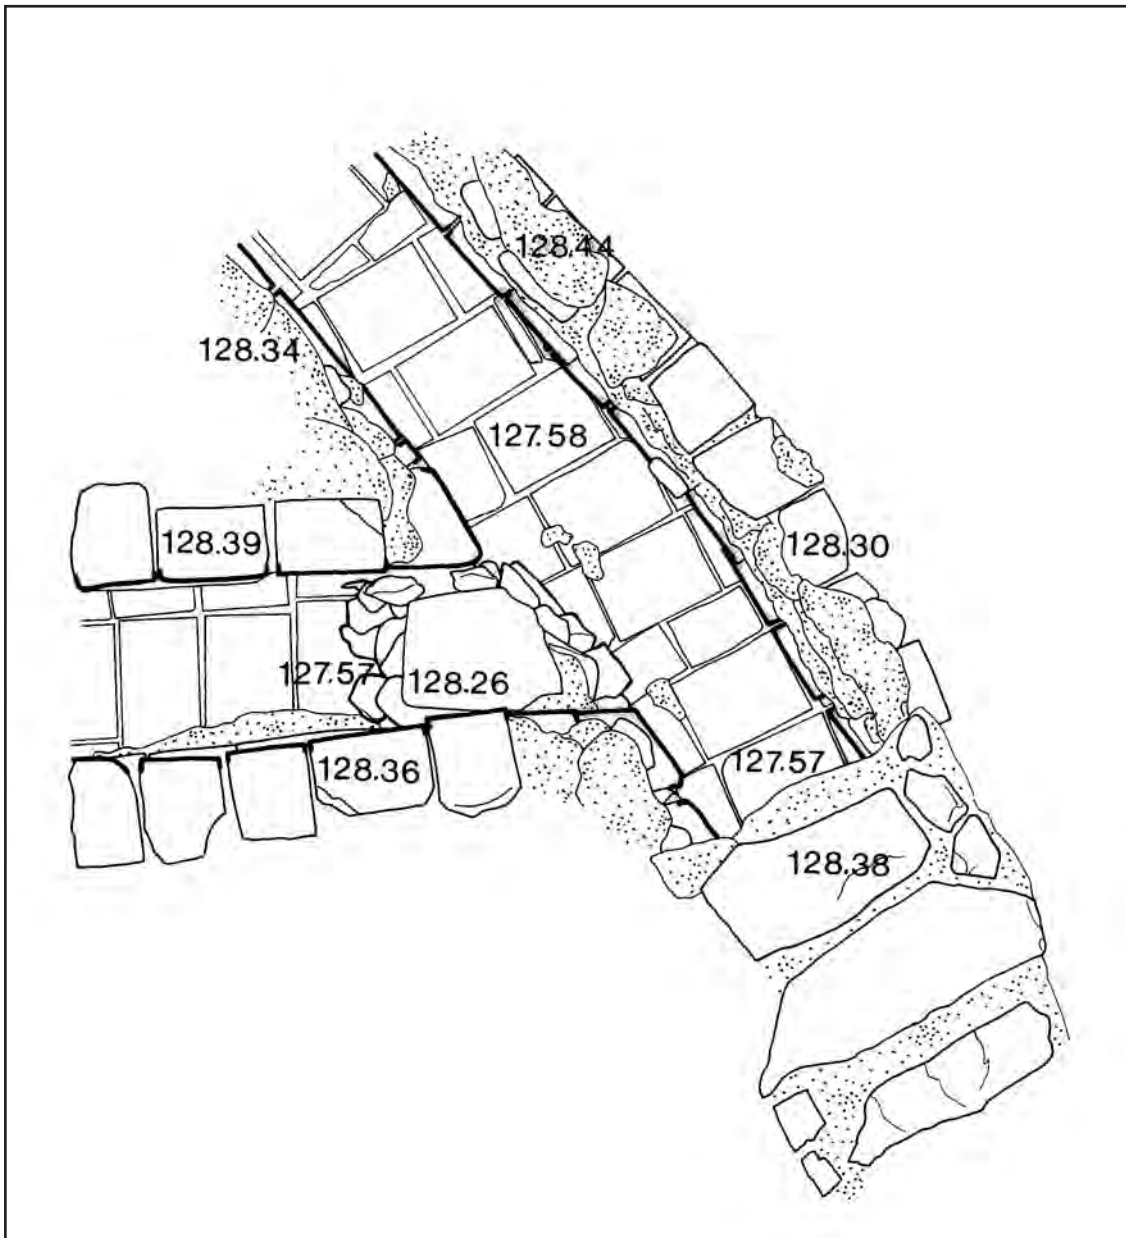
Planta del canal n° 1 y su desembocadura en el canal n° 4, a cubierto, b abierto.
